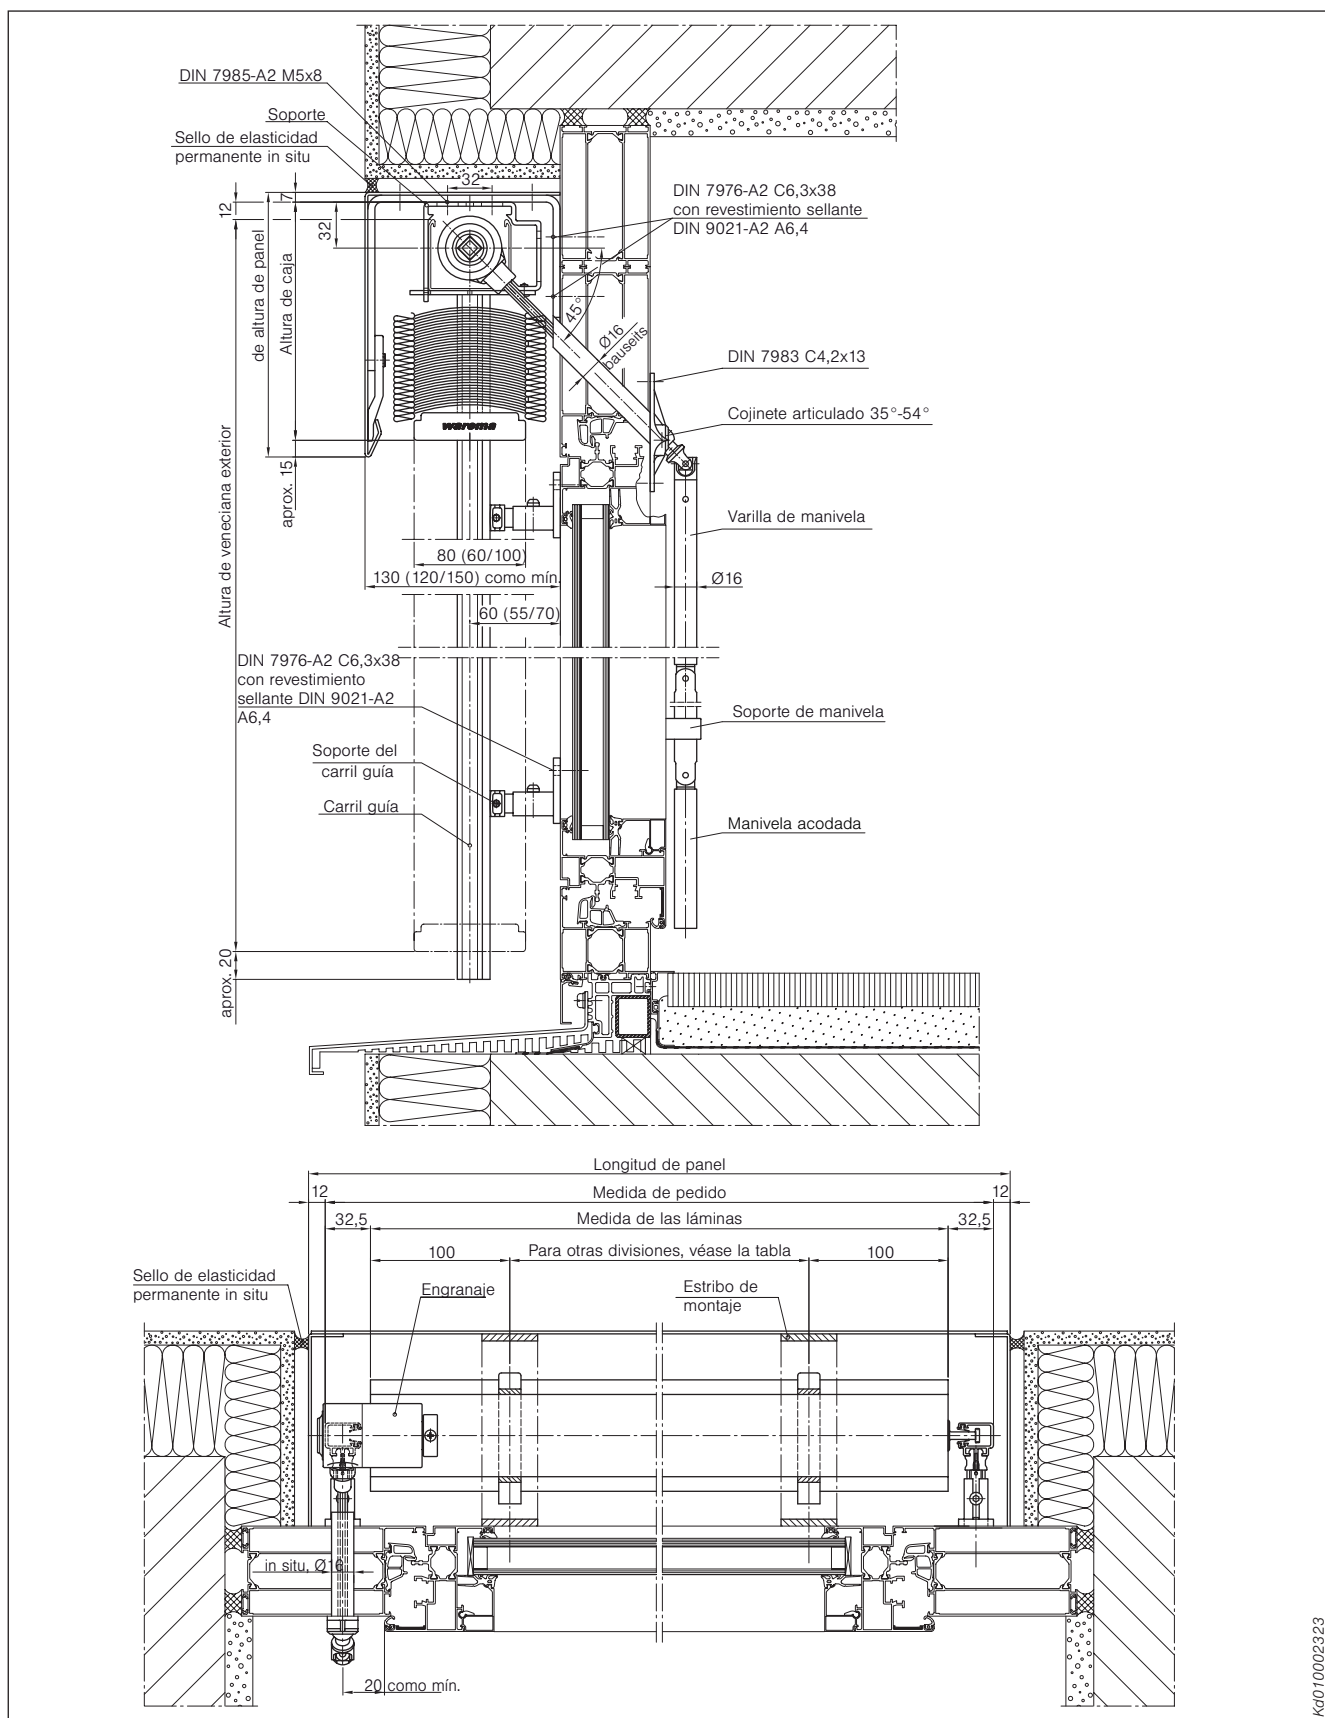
Ejemplo de montaje persianas venecianas exteriores tipos C 60/80/100 AF A6 con láminas planas, carril guía y panel de protección en ángulo
